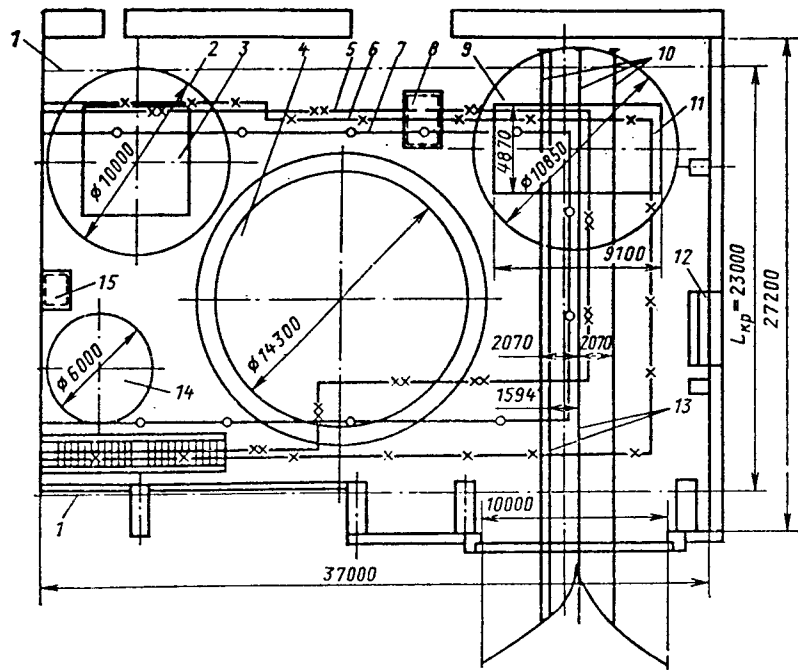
Схема расположения оборудования на монтажной площадке ГЭС:
